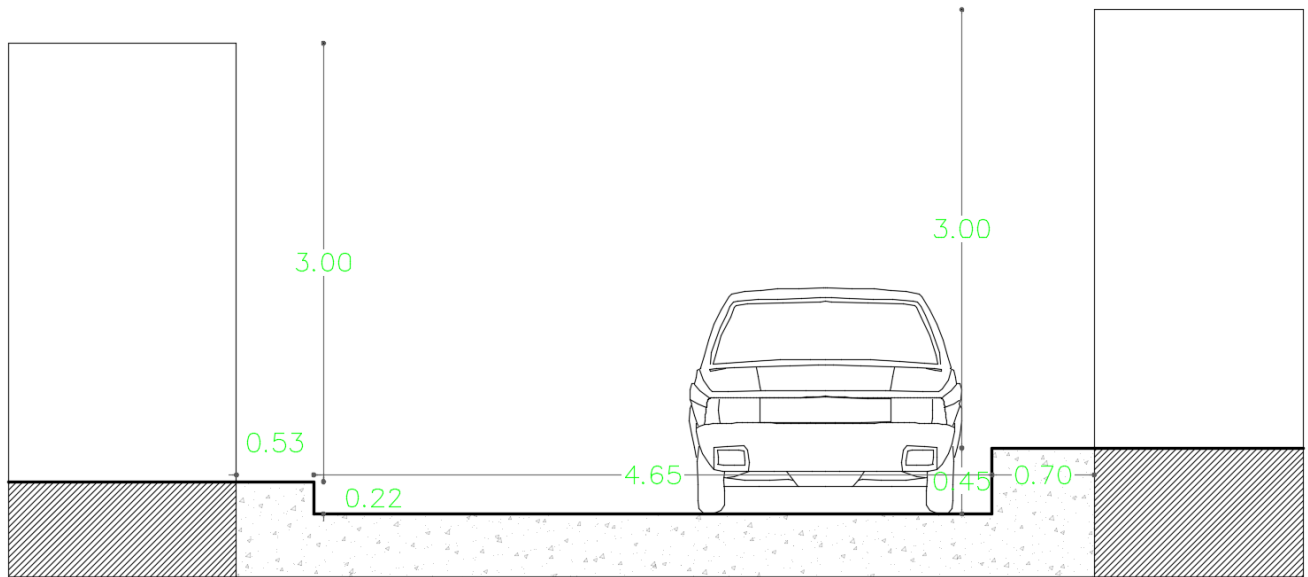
Perfil Vial Entrada Zona Sur y Perfil Vial Entrada Barrio Girasol
